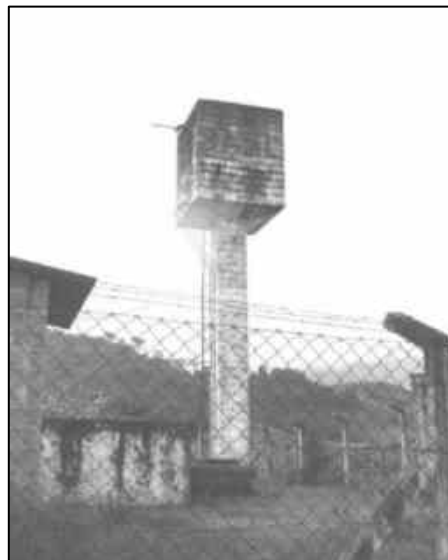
Reservatório elevado, Serra das Estâncias – “de cima” (ETA III) - 80 m³ - Estrutura de Concreto.
